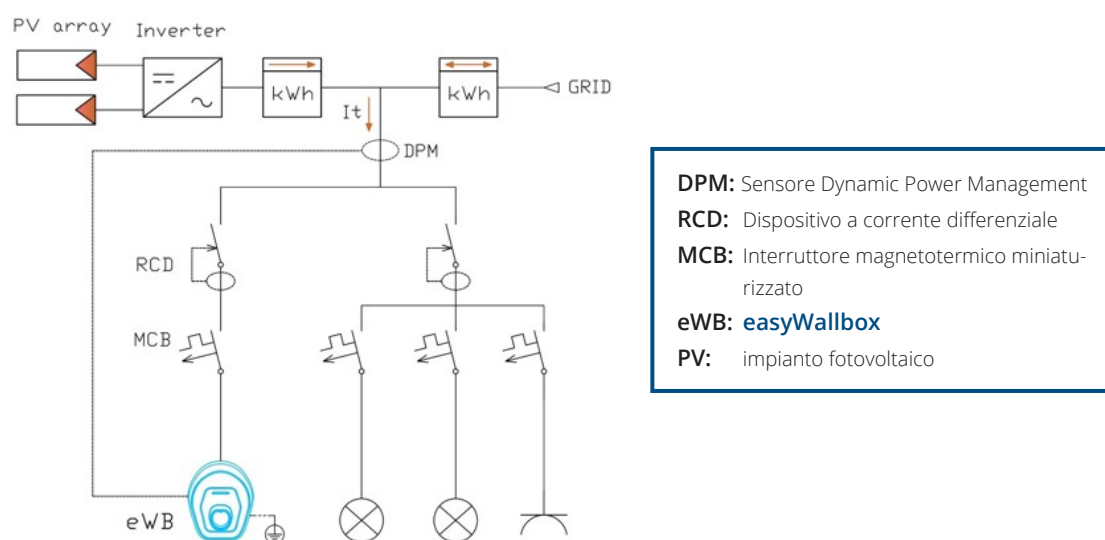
Vista schematica del collegamento di easyWallbox e DPM a un'alimentazione con impianto FV in modalità Power Upgrade
